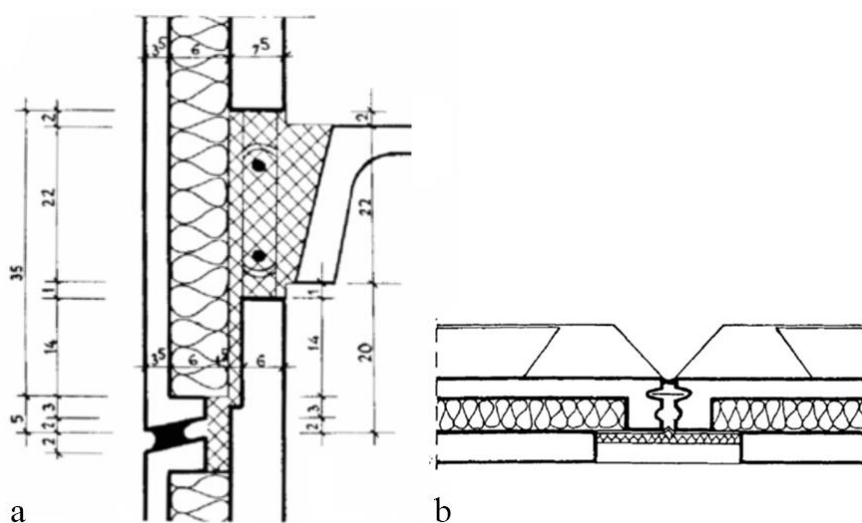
Formiranje zidova za ukrućenje: a) vertikalno nastavljanje panela, b) horizontalno povezivanje panela sa stubovima (Brujić, 2001)
